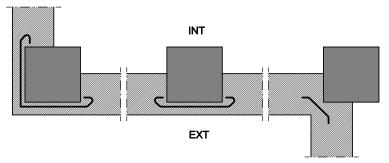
Ejemplo de encuentro de la fachada con los pilares
